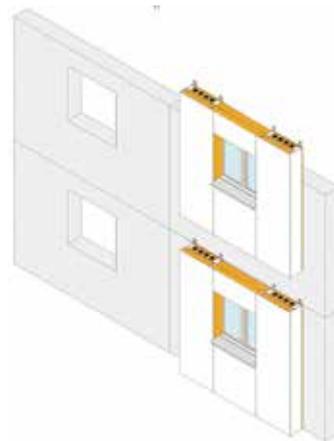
Fassadenelemente mit Luftleitungen. Quelle: Projekt CCEM [4]
